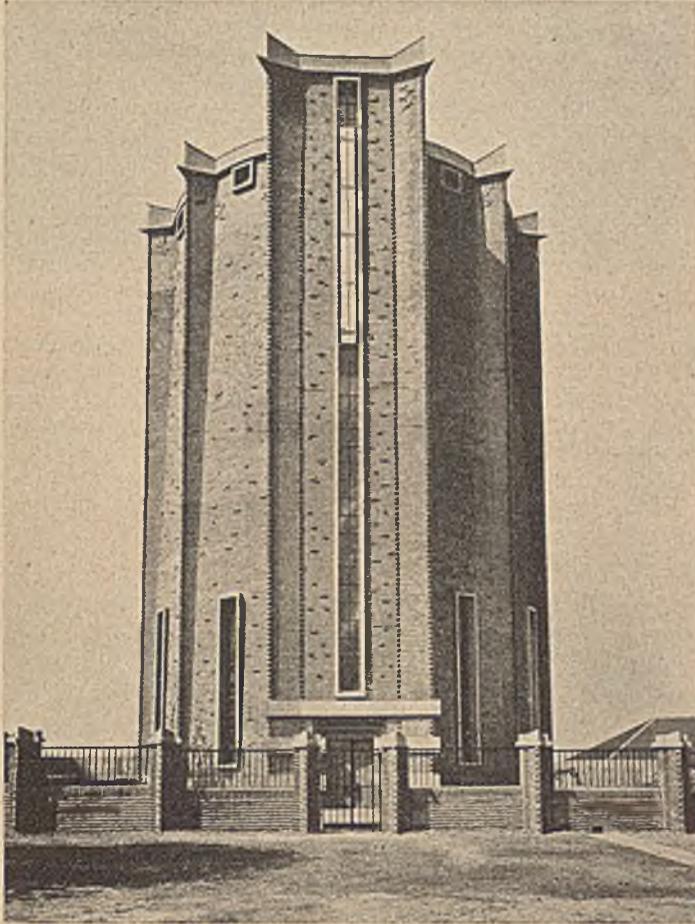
Wasserturm Stoppenberg bei Essen. Außenansicht.
